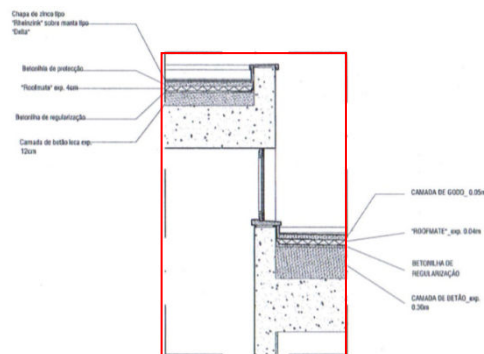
Pormenor construtivo de cobertura mais elevada do edifício C
